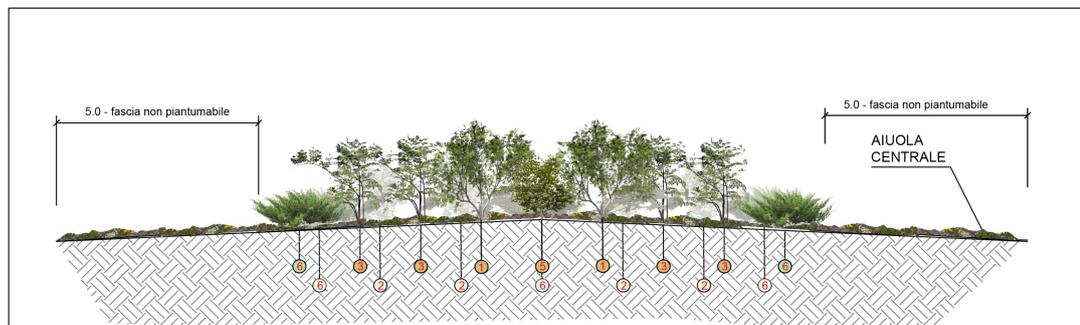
Prospetto piantagione rotatoria modulo PI-RO 2
